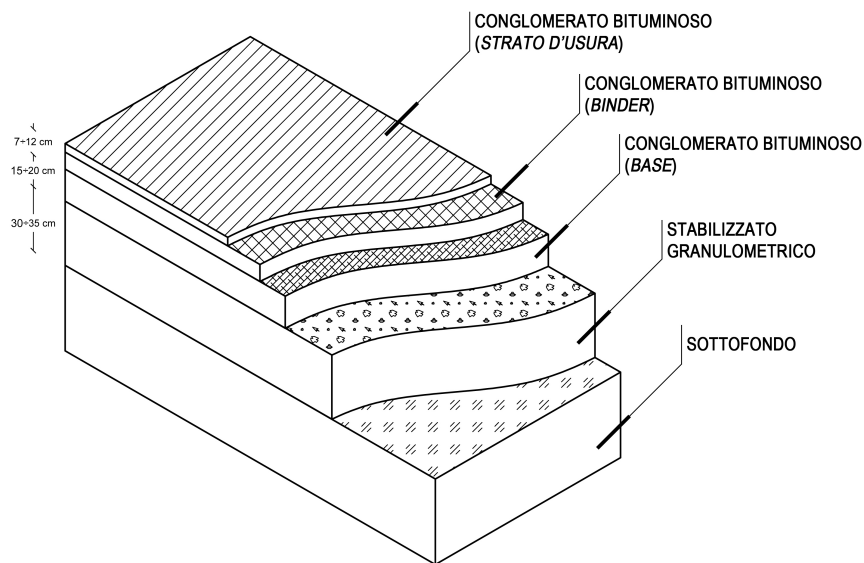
Sezione di una pavimentazione stradale flessibile
